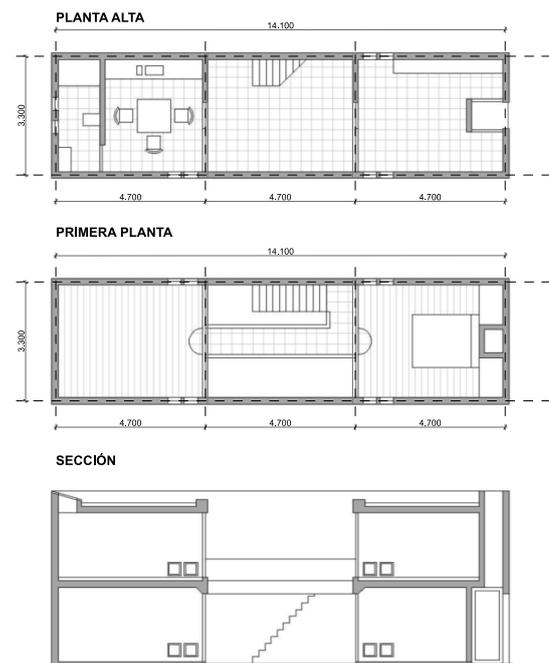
Plantas y Corte de la Casa Azuma, Tadao Ando
